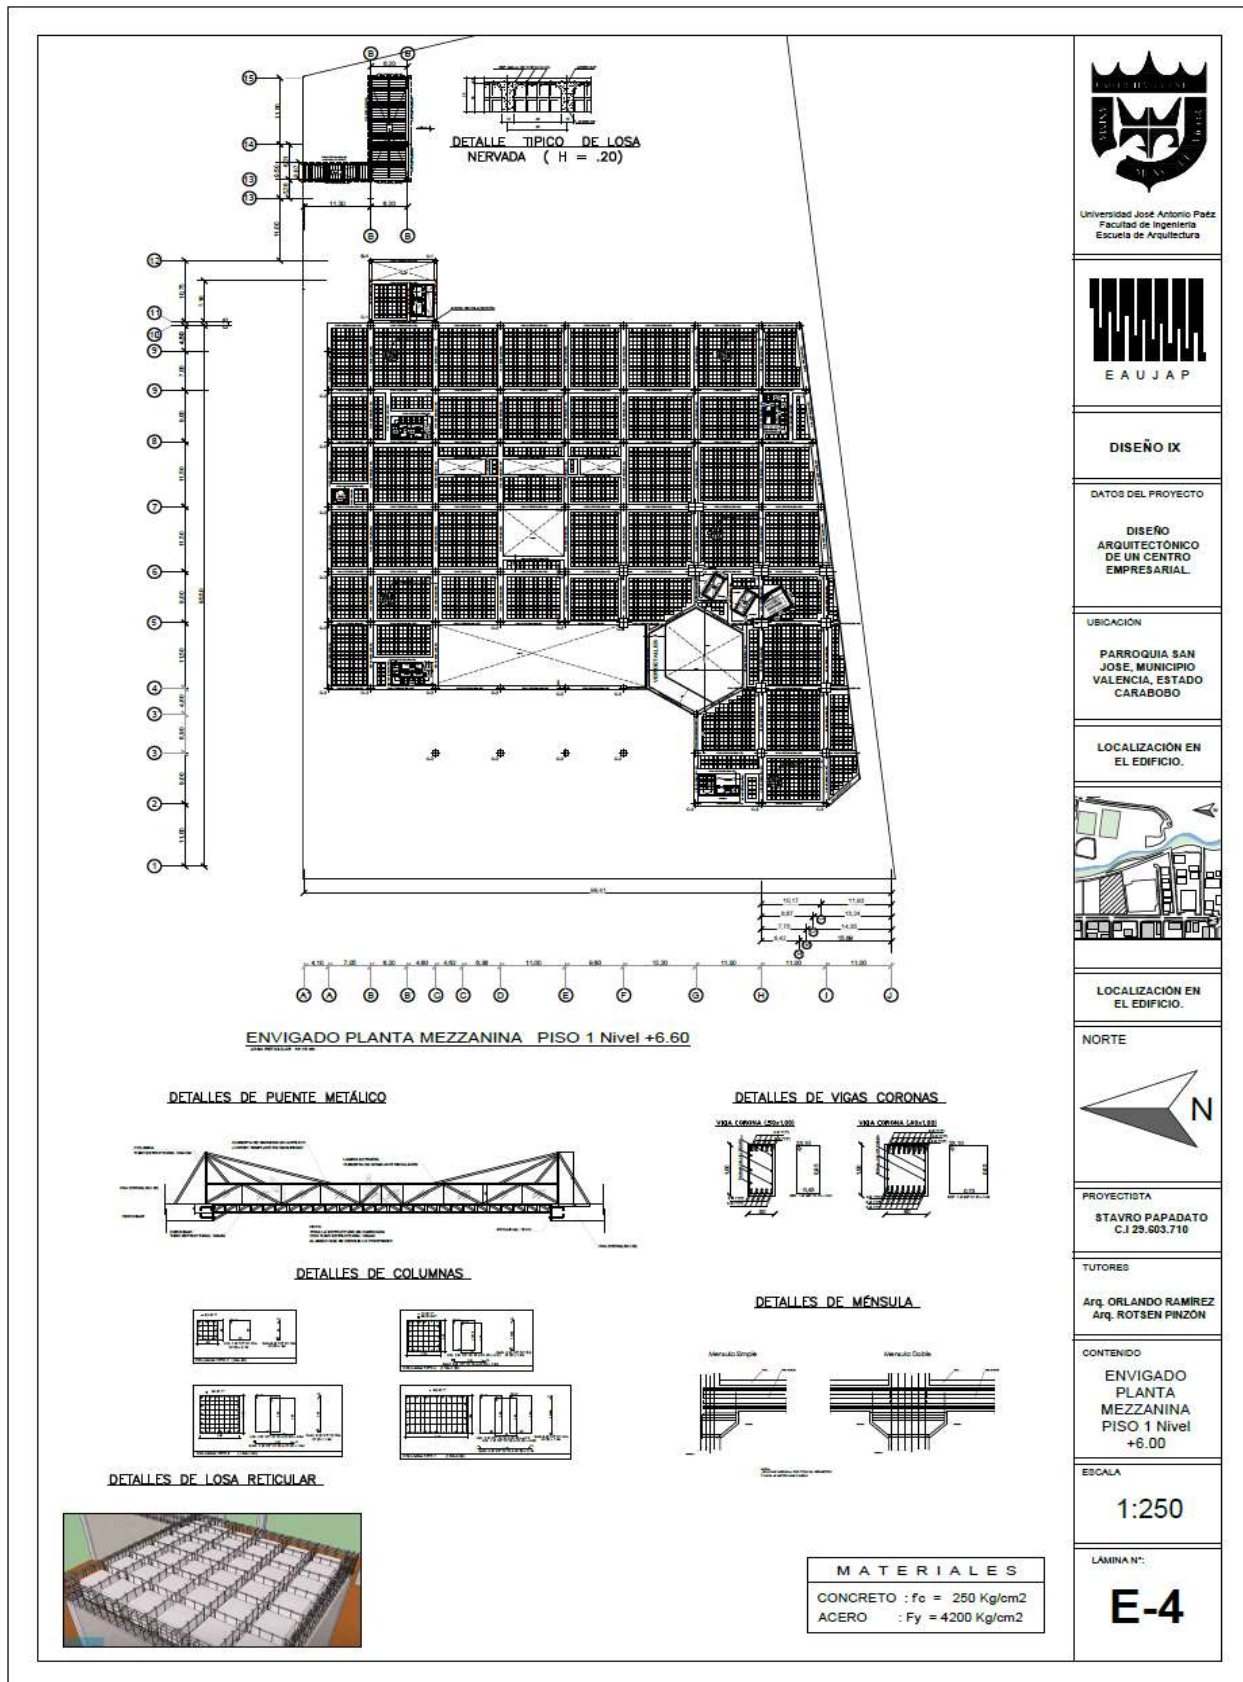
E4 Envigado Planta Mezzanina. Piso 1. Nivel +6.00 Fuente: El Autor (2023)
